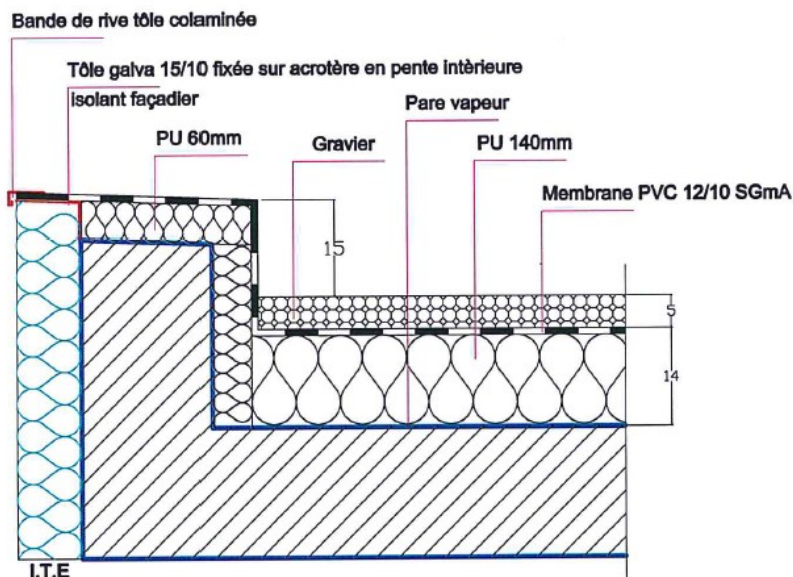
Coupe du complexe d'étanchéité de la toiture
